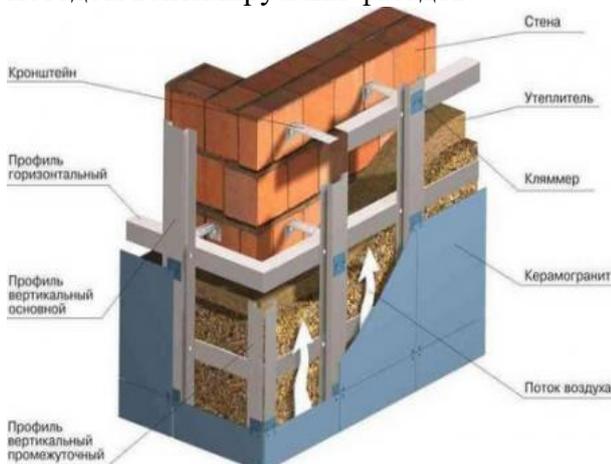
Схема устройства теплоизоляции наружных стен методом вентилируемых фасадов.
